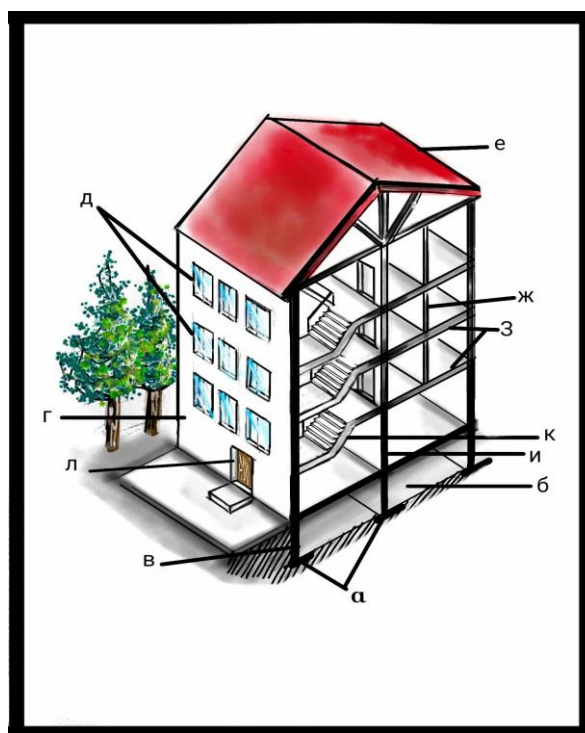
Основные конструктивные элементы зданий: а – фундамент; б – подвал; в – стены подвала; г – наружная стена; д – окна; е – крыша; ж – перегородки; з – перекрытия; и – внутренняя стена, к – лестница; л – дверь
